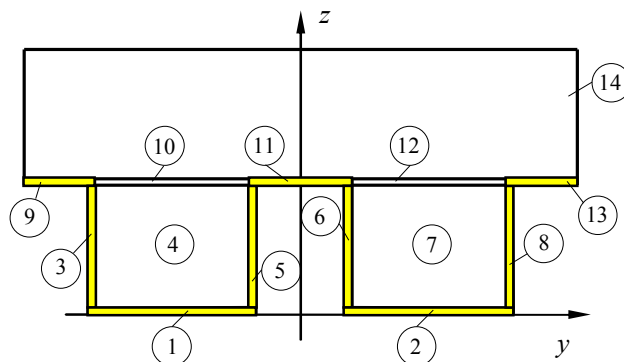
Апроксимований переріз легкобетонної плити з профільованим настилом
